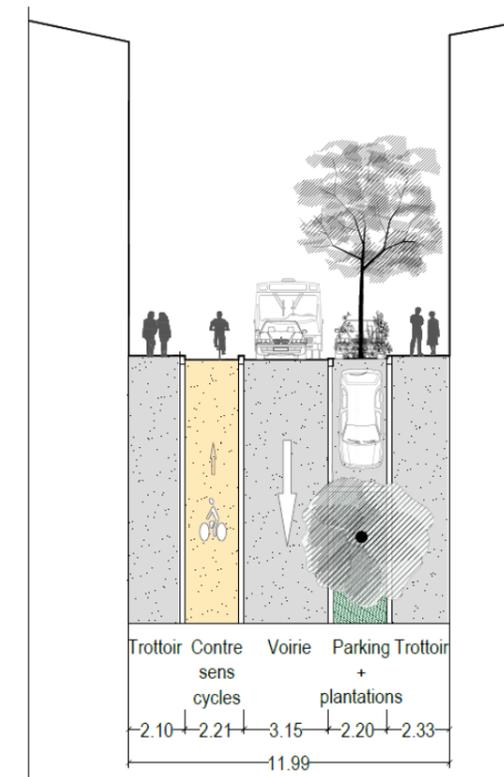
Rue Pierre Sépard - section bus – Coupe 15
